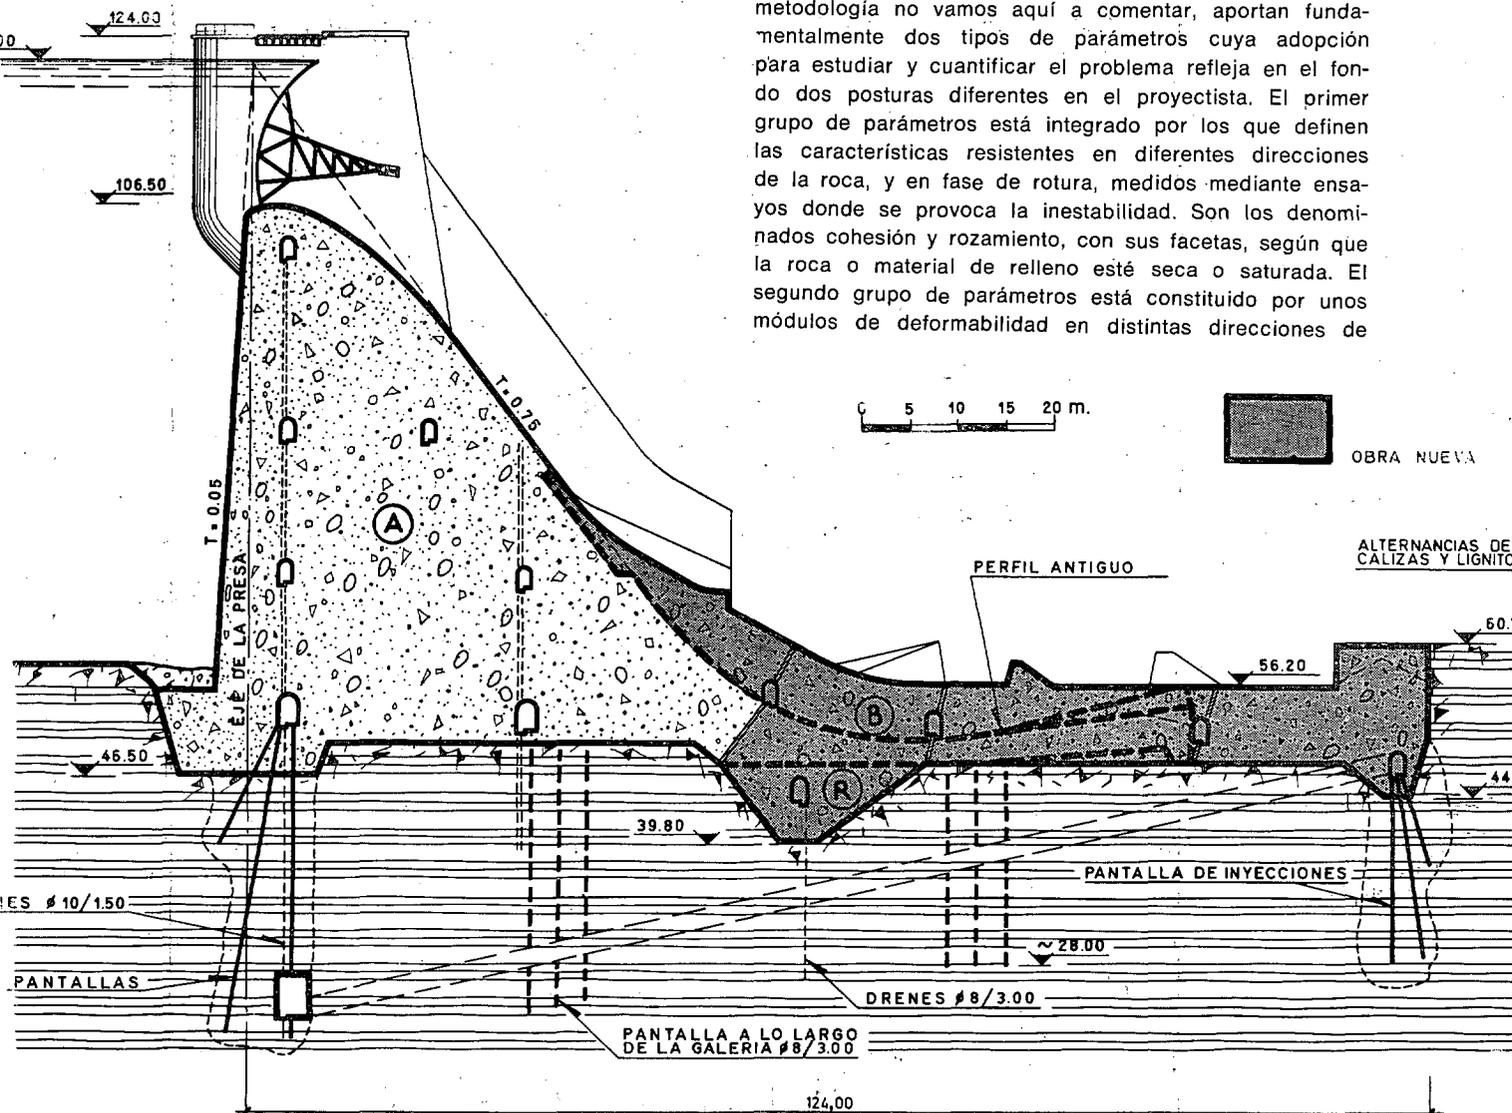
^a—Presa de Mequinenza. Sección principal por aliviadero indicando el cuenco antiguo y la obra de refuerzo ejecutada.
